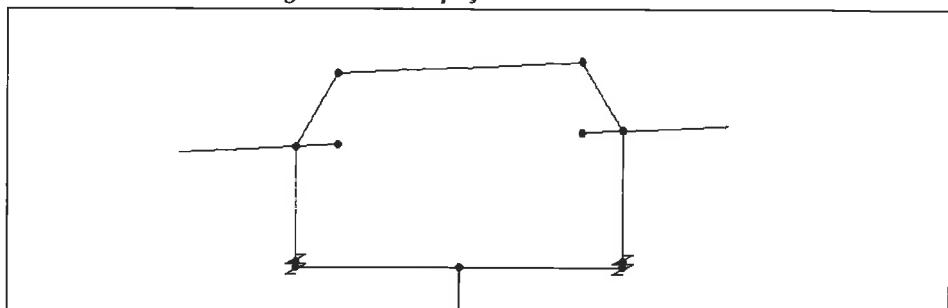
Detaliu privind modelarea plăcii de beton și aparatelor de rezem în zona pilelor
